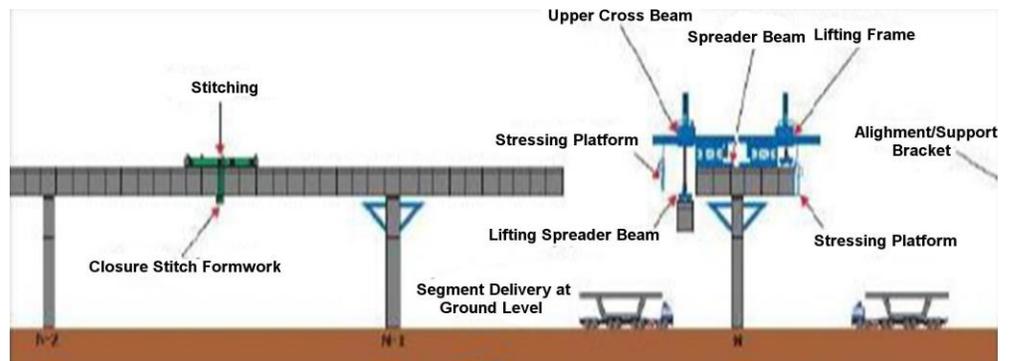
Pekerjaan *Erection Box Girder* dengan menggunakan *Lifting Frame
